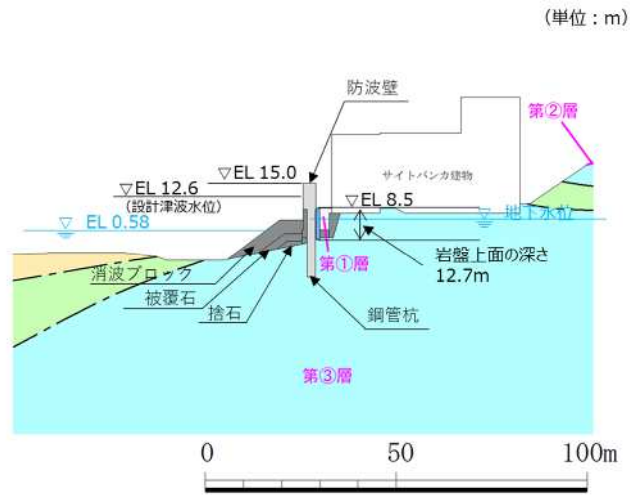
防波壁（多重鋼管杭式擁壁）の横断面図
